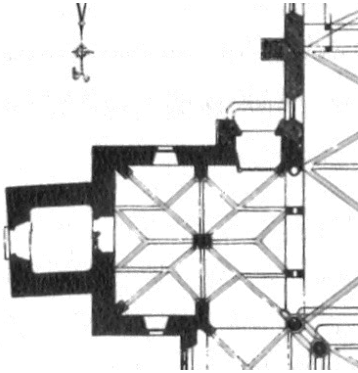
Weweler, St. Hubertus, Grundriss
